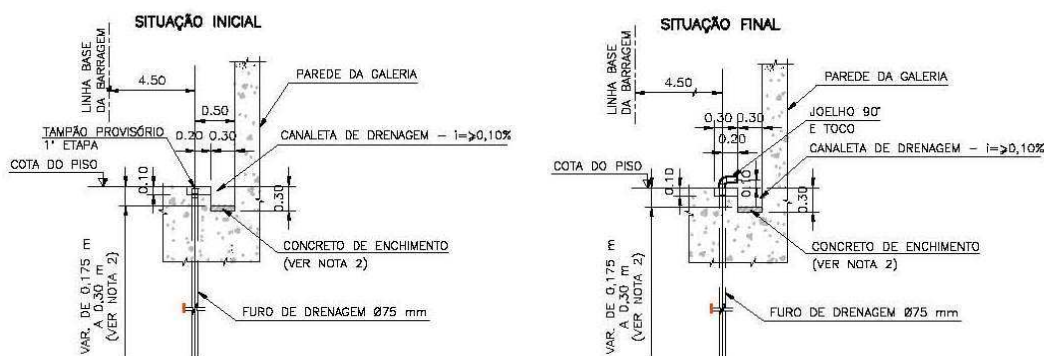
Instalação da extremidade superior dos furos de drenagem da fundação
